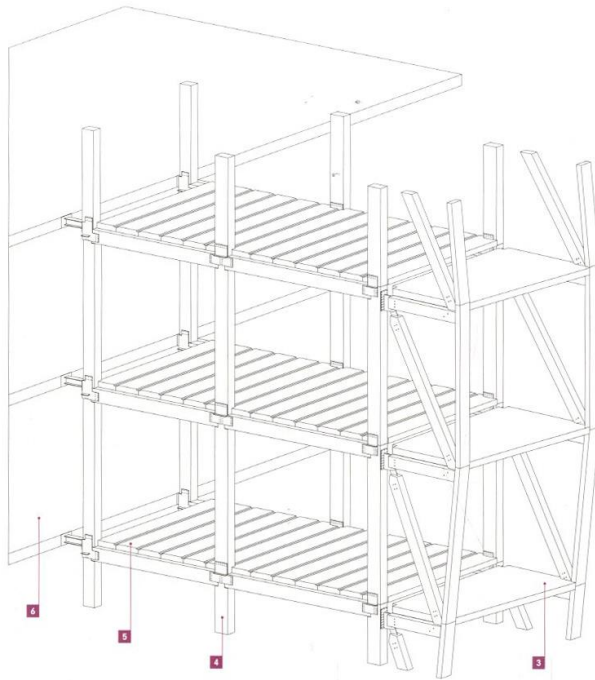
Axométrie de la structure poteau-poutre et panneaux de planchers
